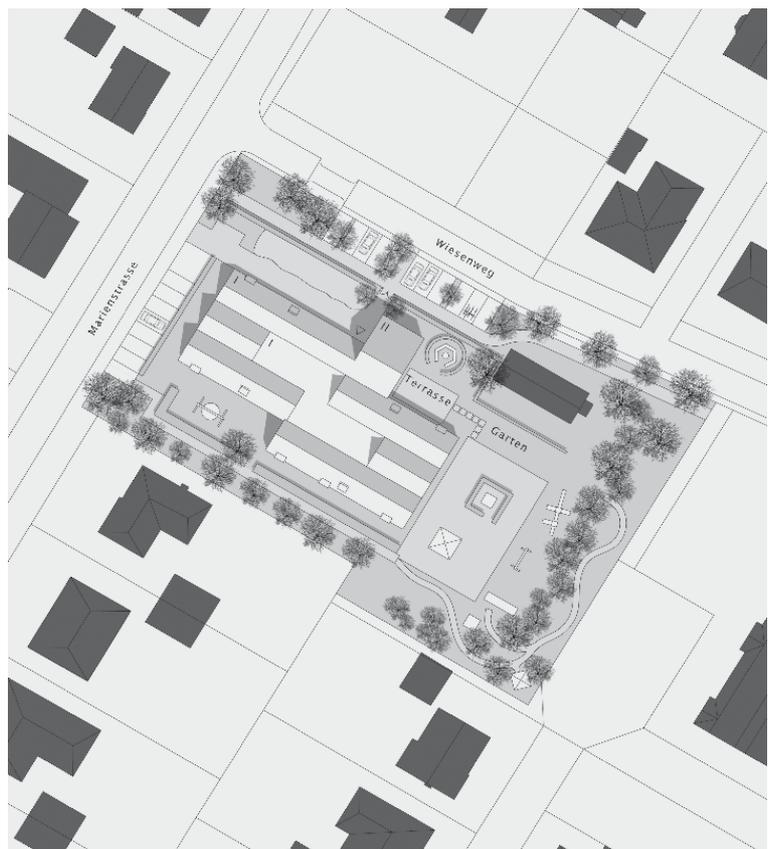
Lageplan "Kindertagesstätte Erika" mit Darstellung der Außenanlagen
